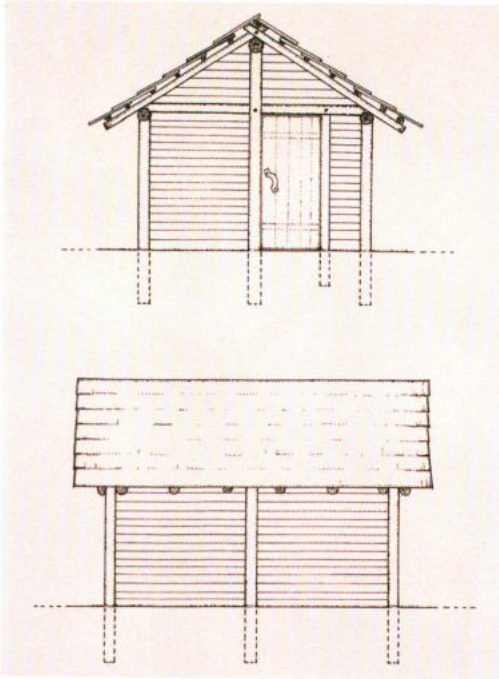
Bauskizze zum neuen Schmiedemodell in Asparn. Ein Pfostenbau mit Riegelwänden und Lärchenschindeldach nach archäologischen Befunden von Bad Dürrenberg; Dimensionen nach Mšec in Böhmen. – Building plan of the new smithy model in Asparn: A post house with rail walls and a larch shingle roof inspired by archaeological data from Bad Dürrenberg; dimensions from Mšec in Bohemia.
